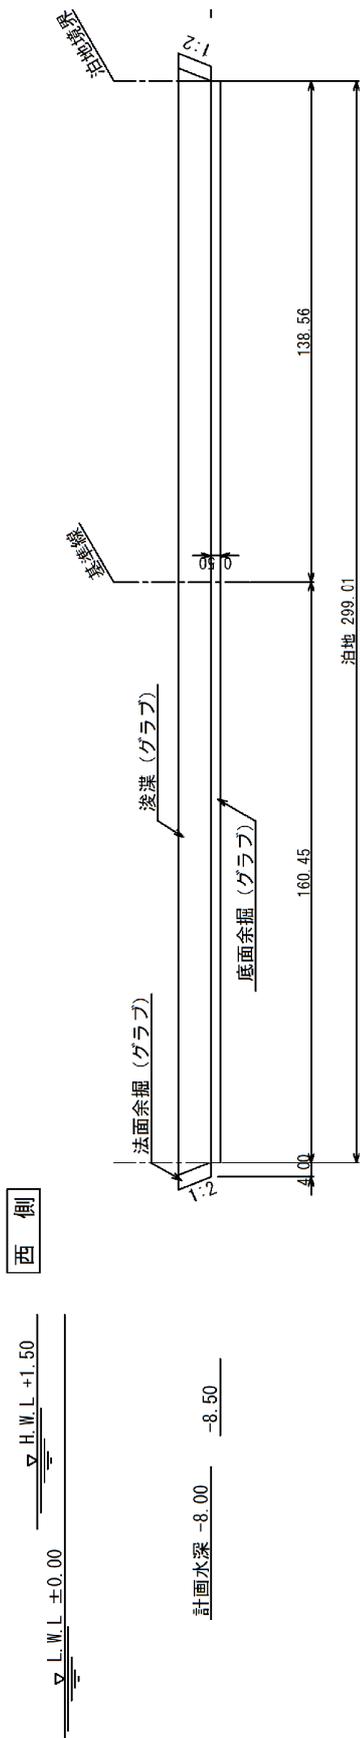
No.2 大洗港区_中央地区泊地 (-8m) の断面図 (被災前)
